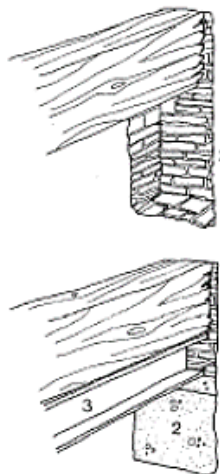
Elaboración de dado de hormigón y colocación de perfil.
